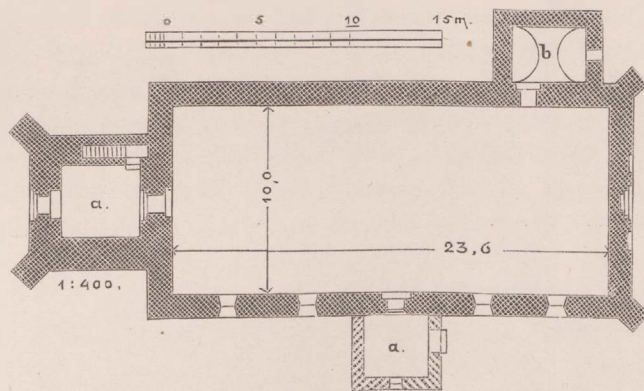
Mockrau. Grundriss der Kirche.
